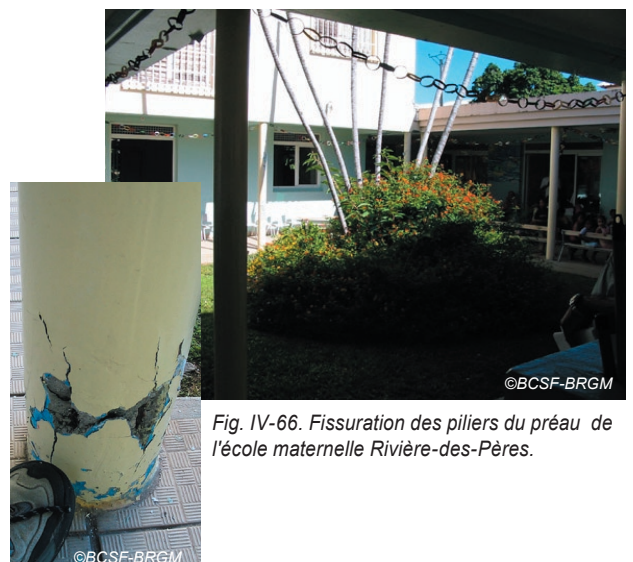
Fissuration des piliers du préau de l'école maternelle Rivière-des-Pères.
